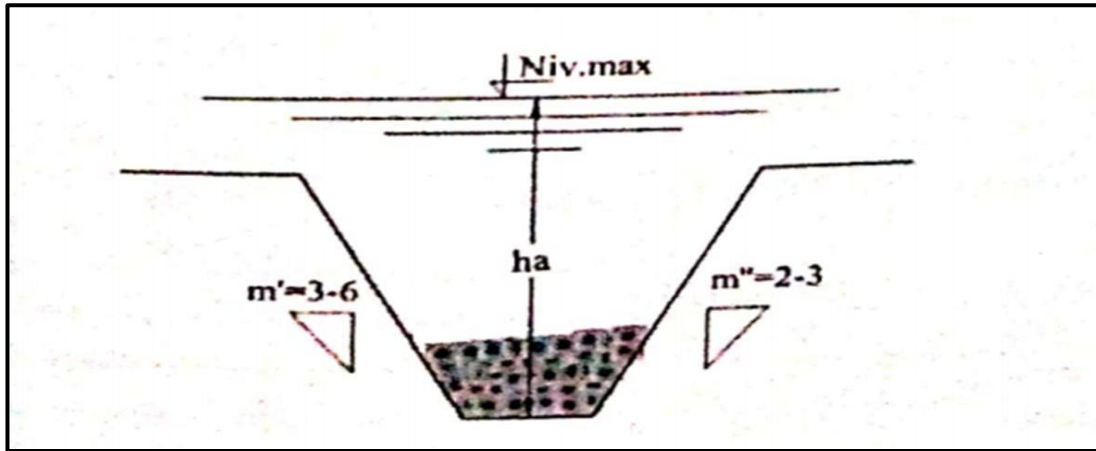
Coupe longitudinale d'une fosse d'affouillement (source : Mihoubi, 2019)
